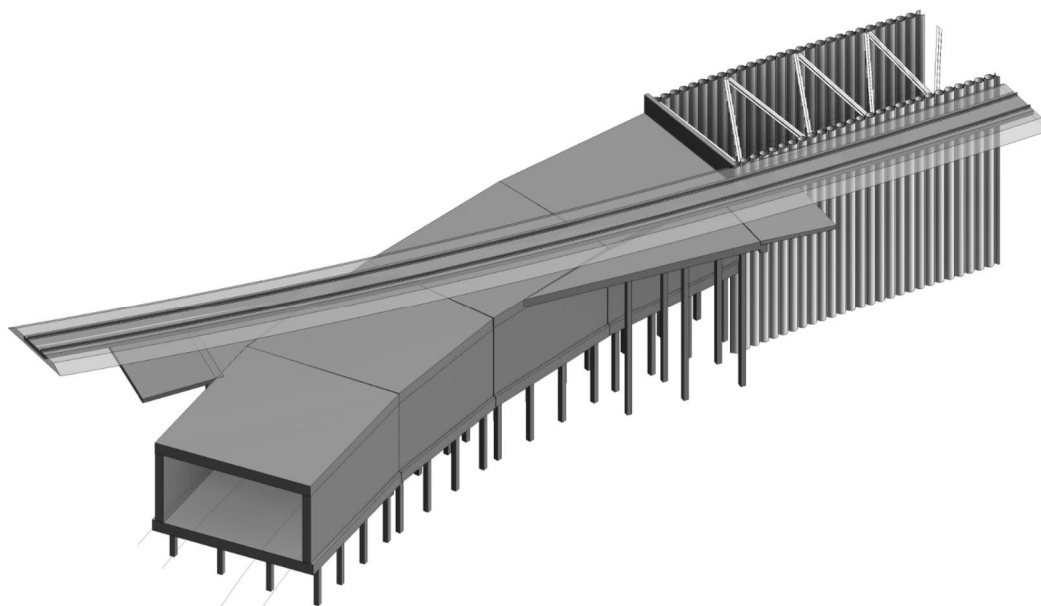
Tyypipoikkileikkaus betonitunnelista
